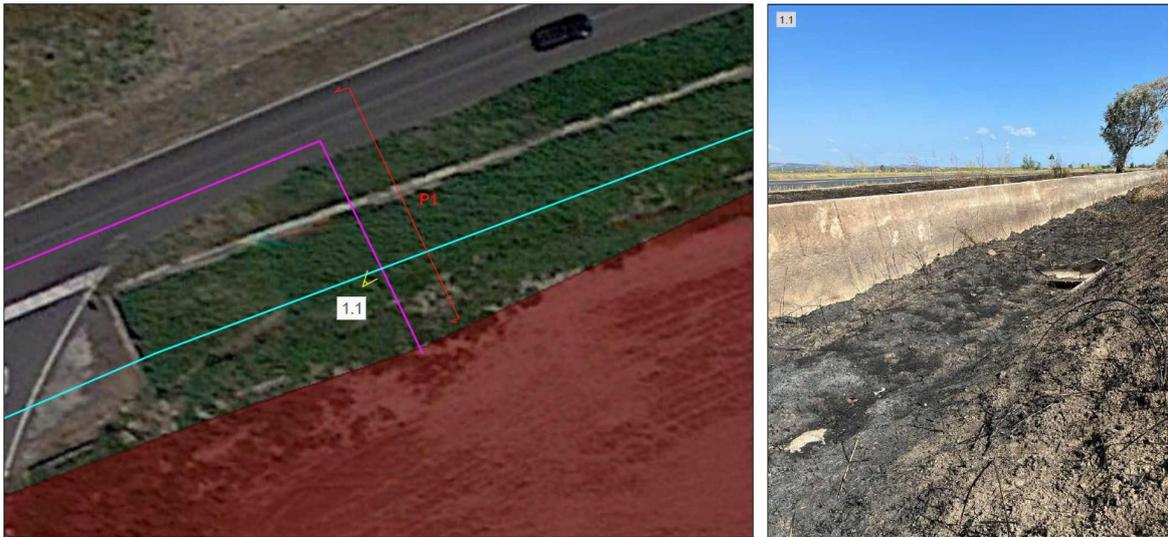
Attraversamento idraulico n.1 – Canale a perimetro dell'area di impianto - Stralcio su ortofoto e foto
